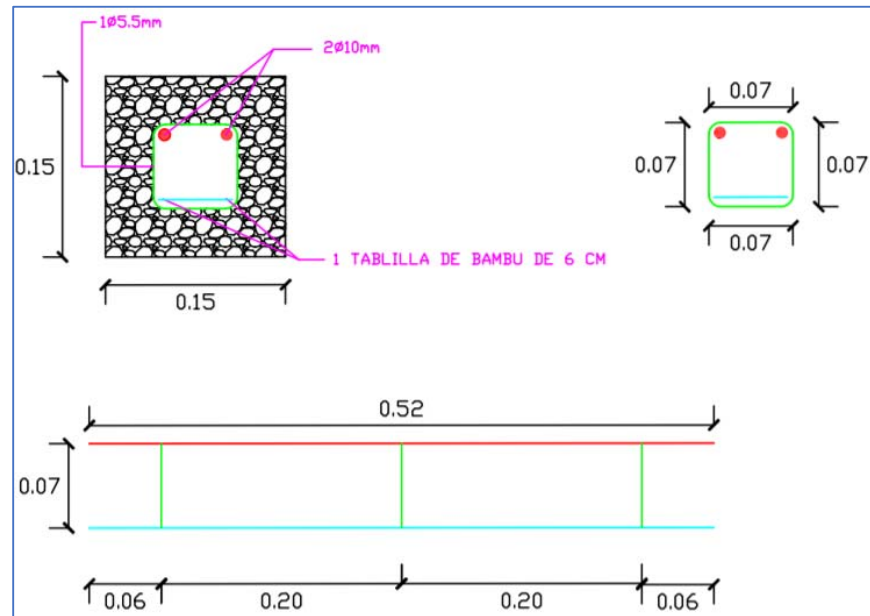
Esquema de vigueta con refuerzo mixto (bambú tablilla y acero)
